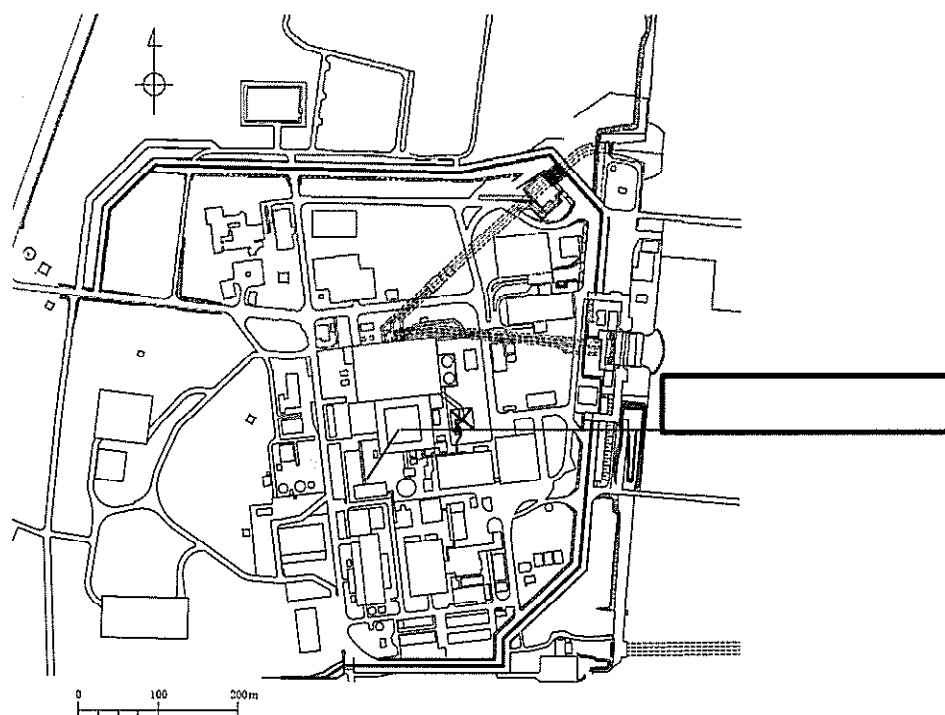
(1) 常設代替高圧電源装置用カルバート（カルバート部）の平面配置図（全体平面図）
